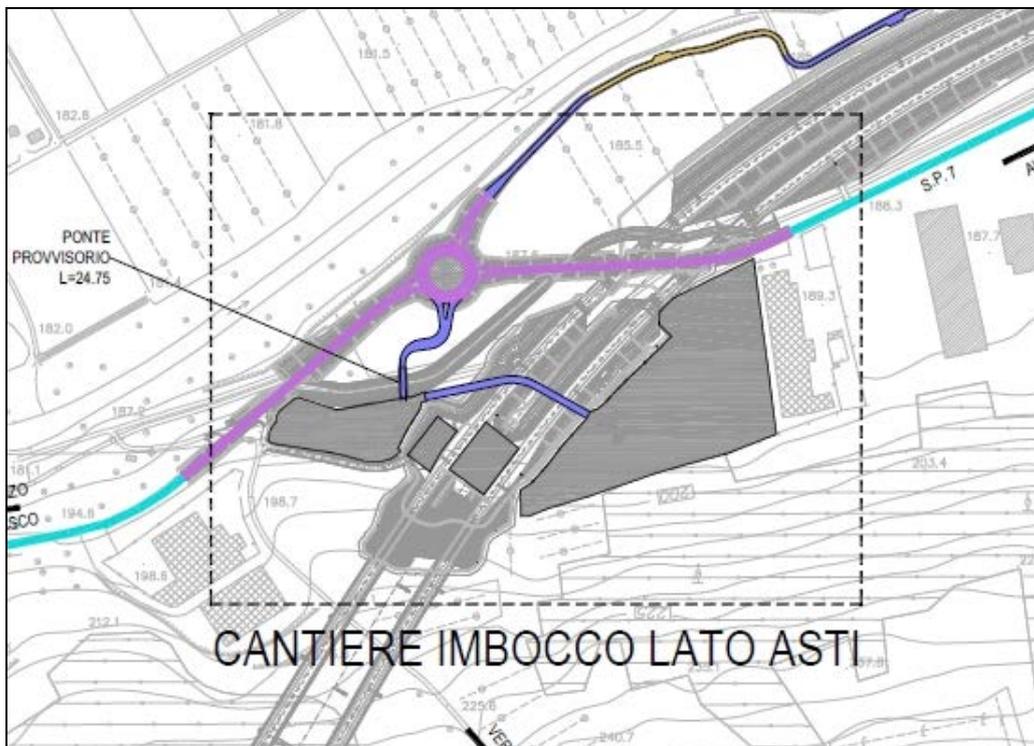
Localizzazione Cantiere Imbocco Lato Asti
